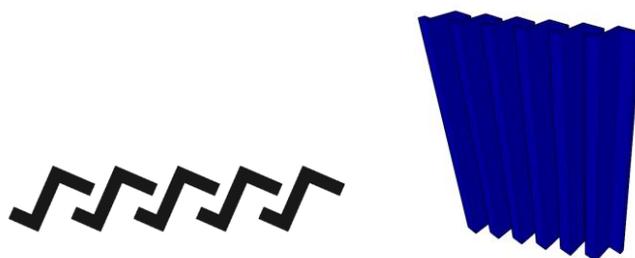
Brise em concreto armado. Fonte: 3D projeto;
